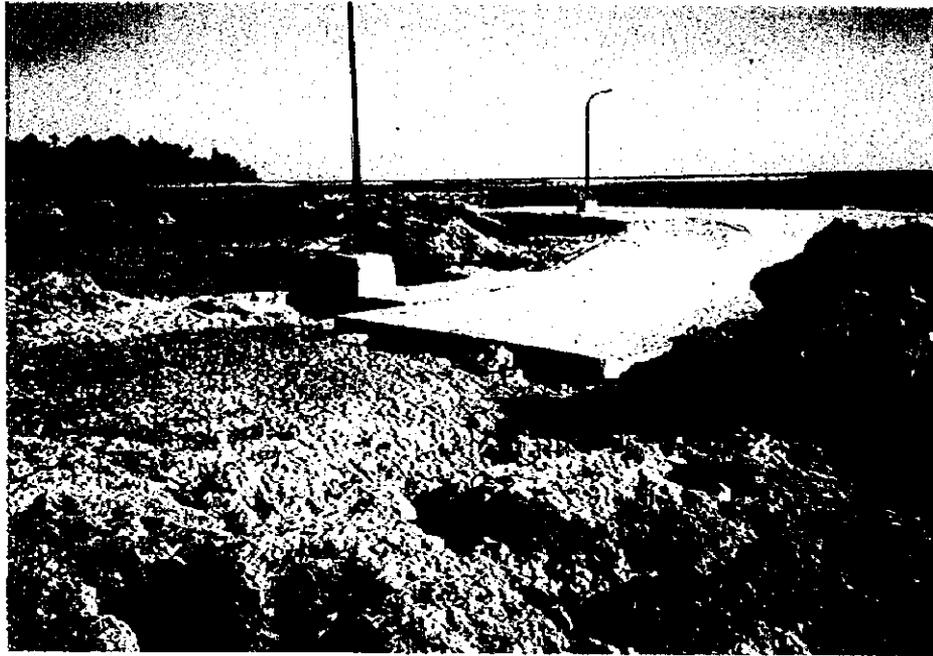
取り付け道路簡易舗装部の侵食状況とコンクリート舗装部分
